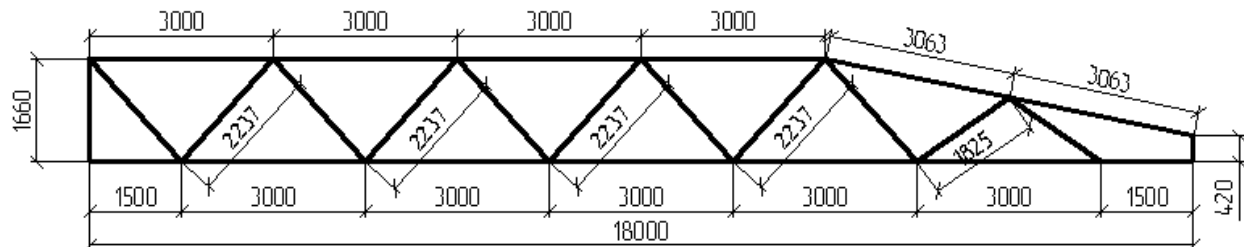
Геометрические размеры фермы покрытия Фм-2
